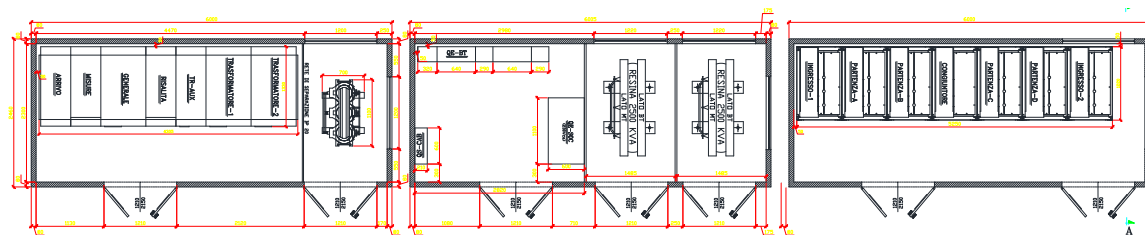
Planimetria delle cabine Molo Nord e Banchina Riva.
